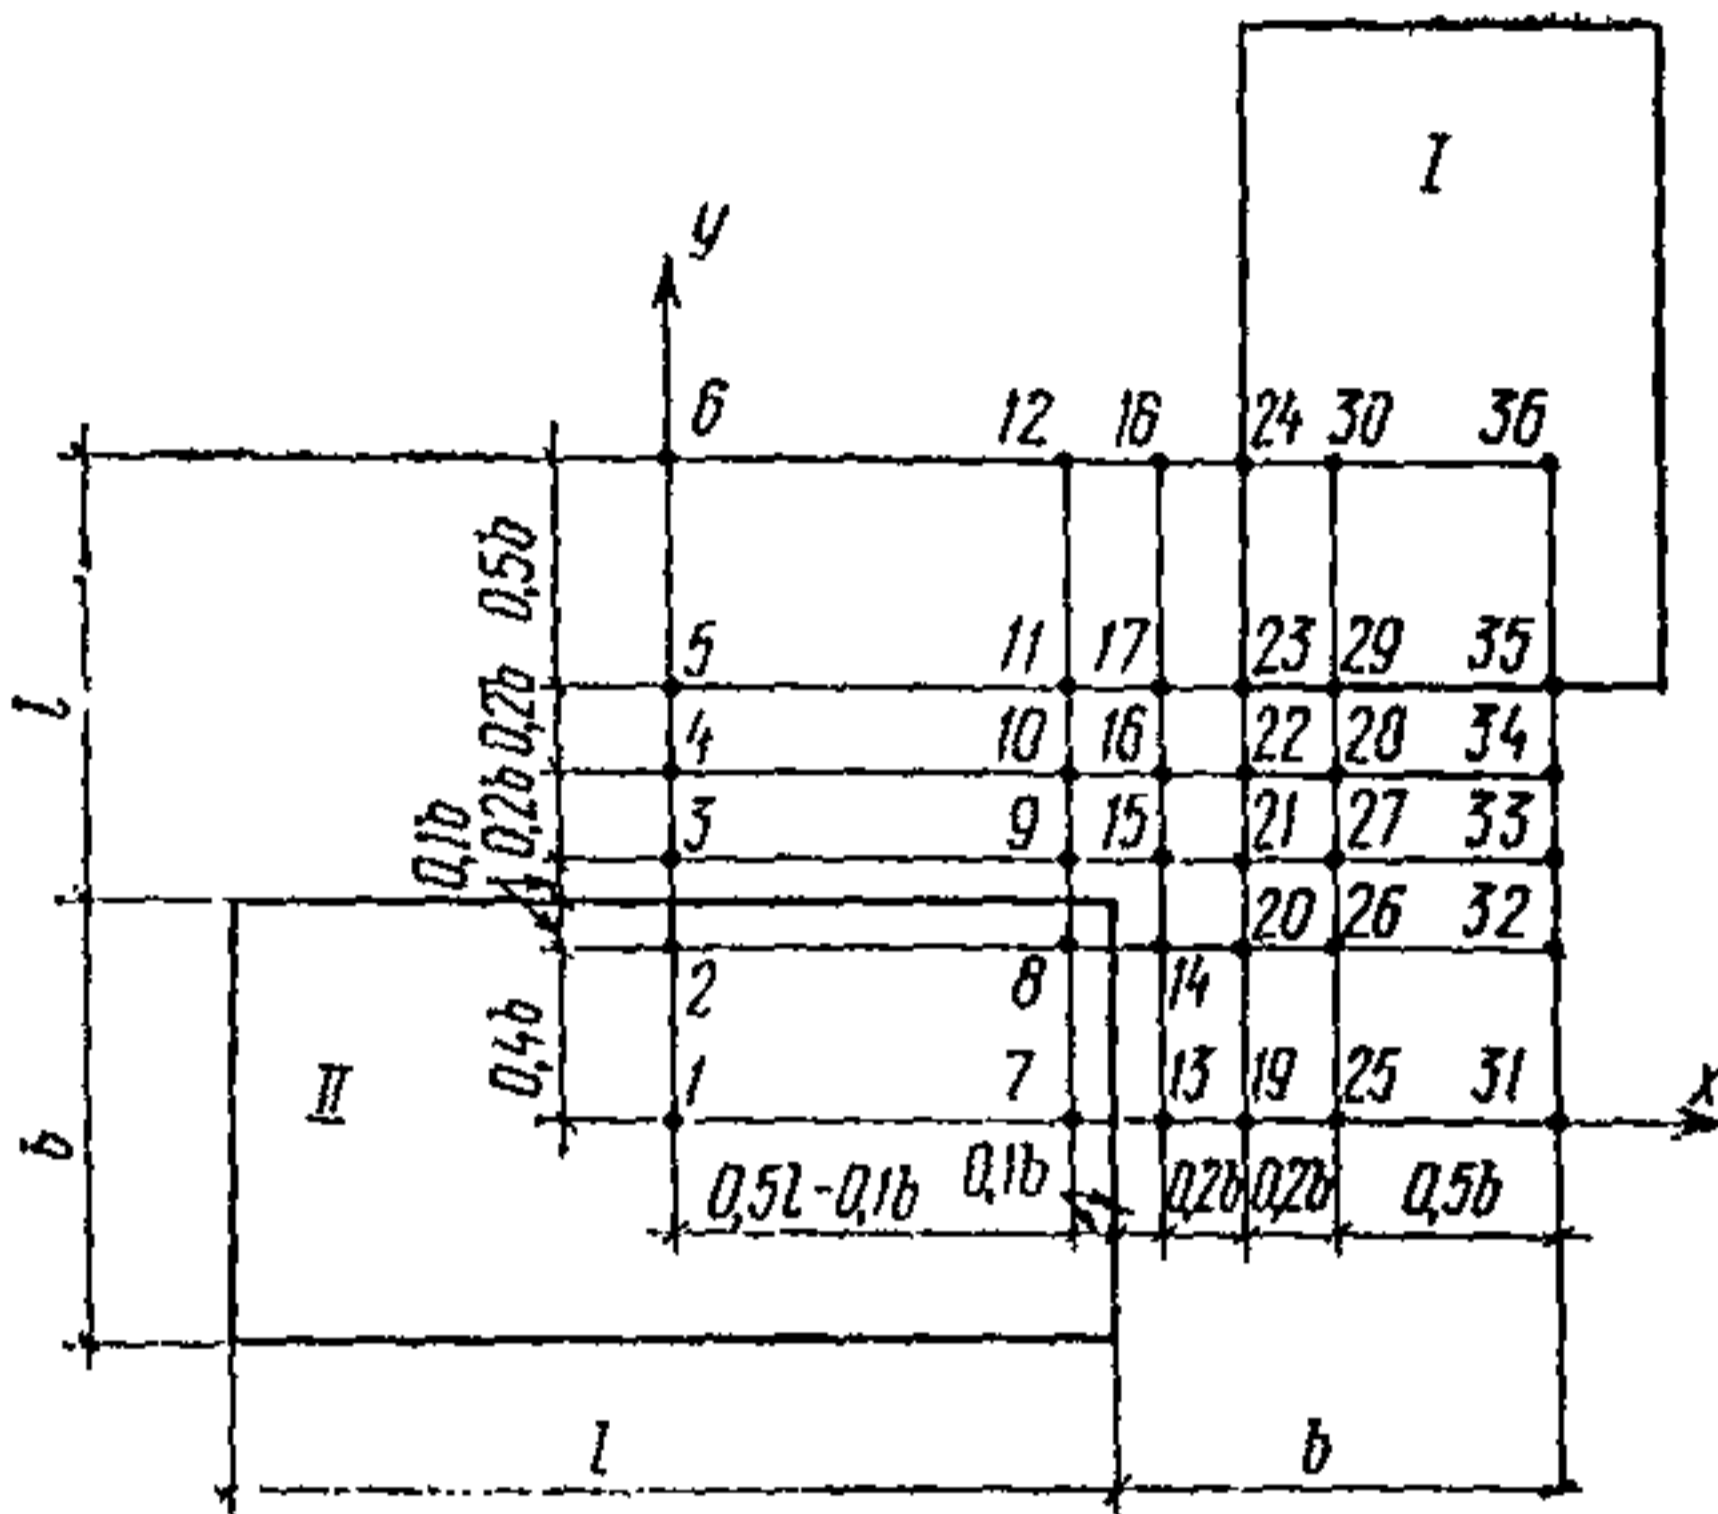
Схема расположения фундаментов при определении дополнительных осадок рассчитываемого фундамента от влияния соседнего
